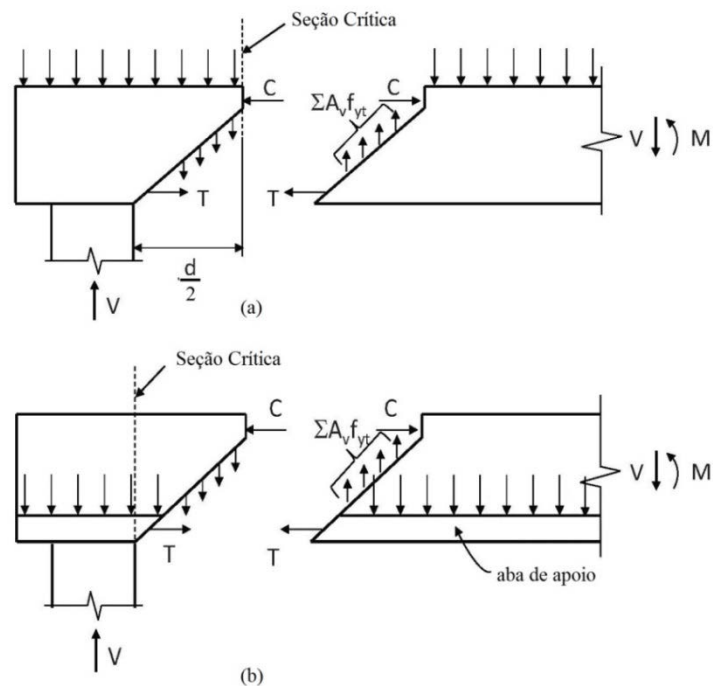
Posição da seção crítica para o cisalhamento em vigas. (a) apoio direto; (b) apoio indireto. [adaptado de ACI 318:2014].
